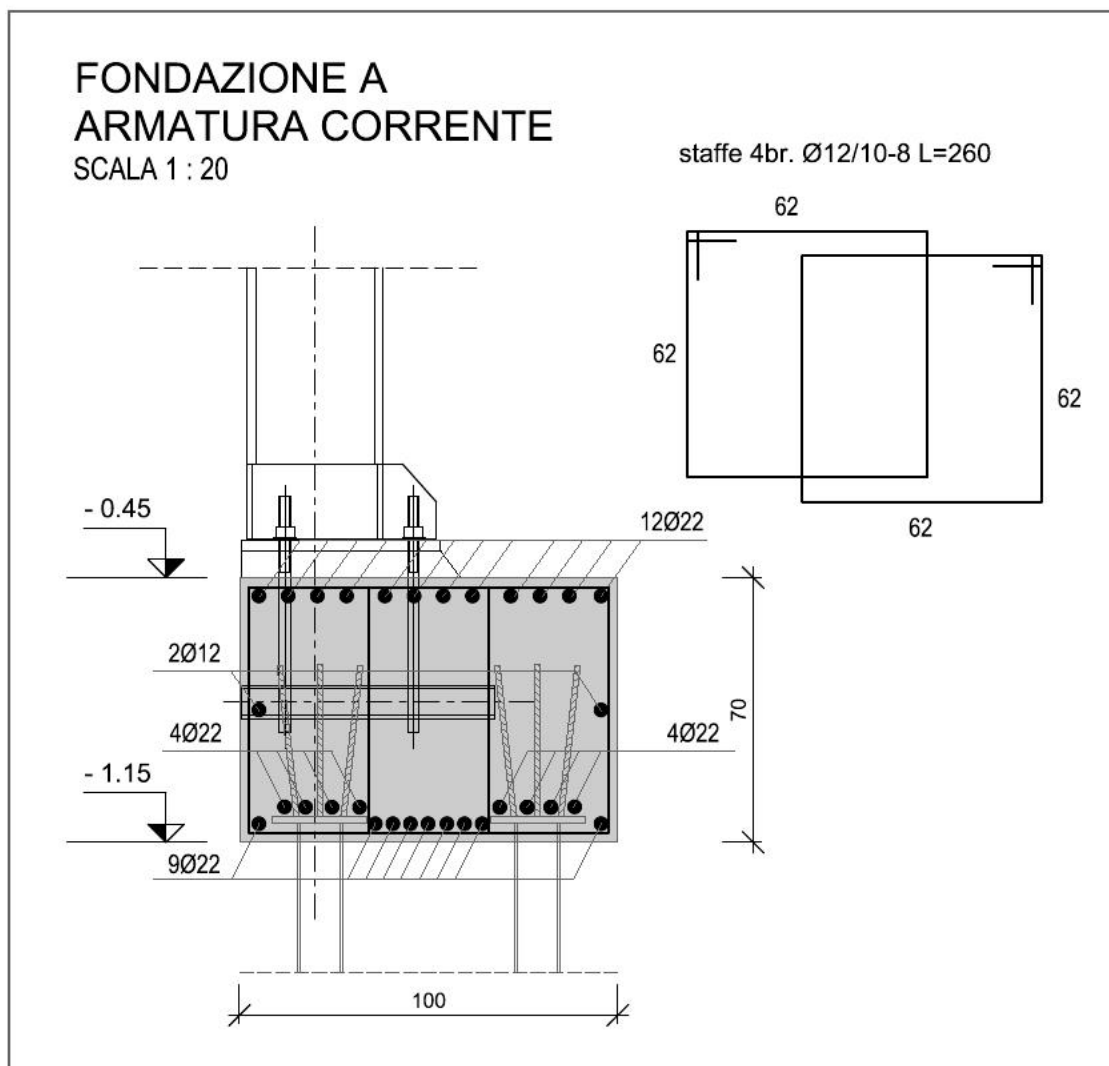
Particolare di A.2006.a.us.T02 - Pianta e particolari fondazioni - Particolari trave tipo A
